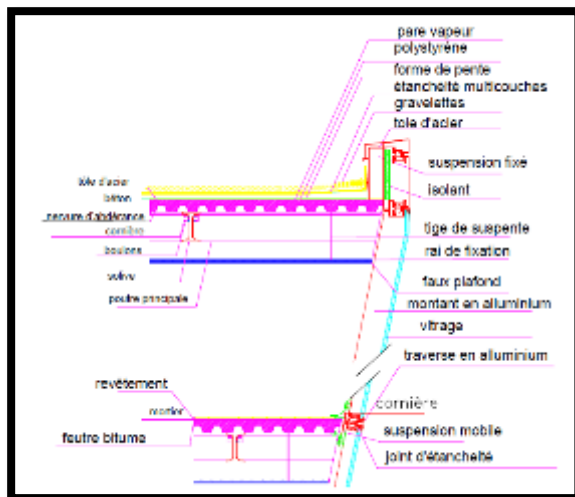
détail de planchers collaborant, mur rideau incliné et faux plafond .Source : auteur
